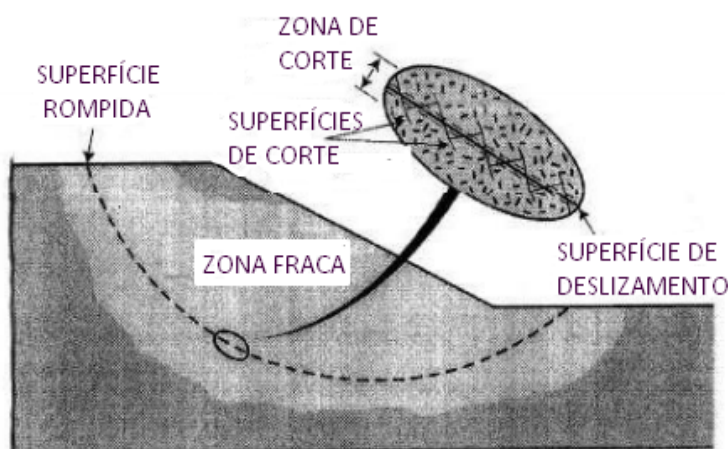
Zona fraca, zona de corte e superfície de de corte, [3].
